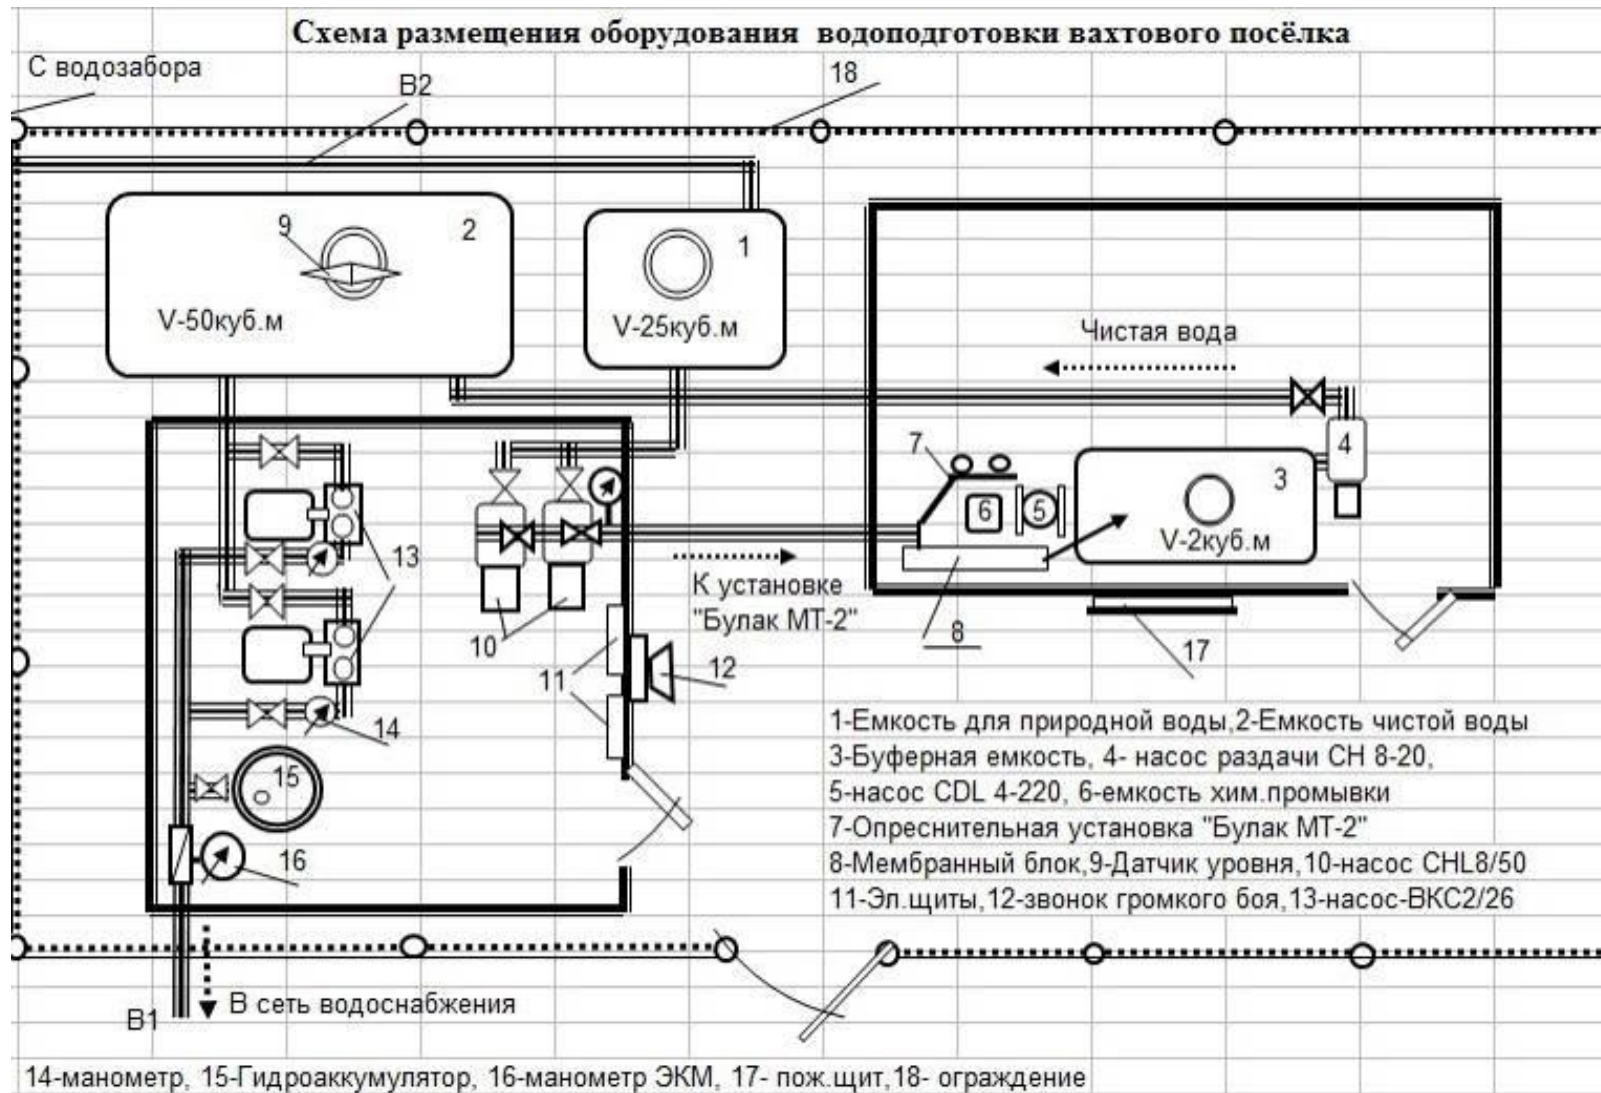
Схема размещения оборудования водоподготовки вахтового поселка
